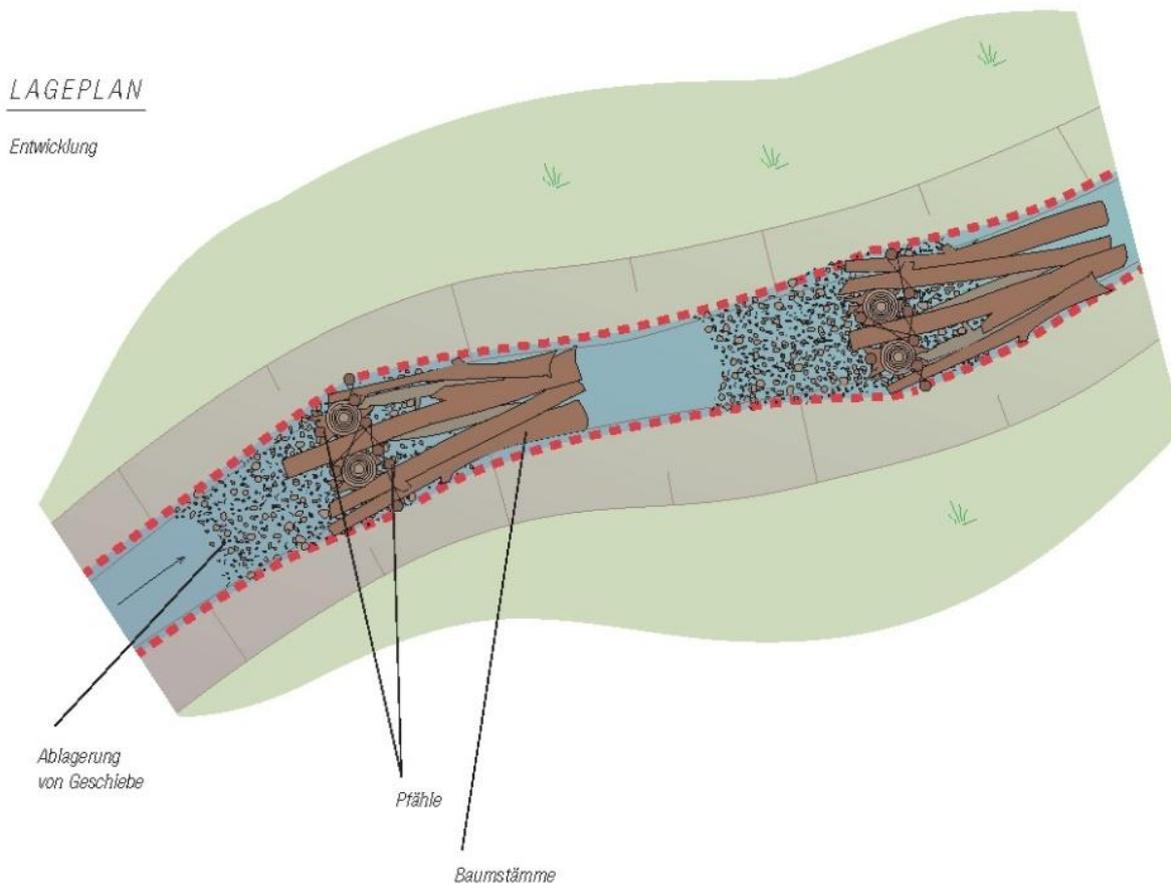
Grundschwelle aus Totholz Lageplan (LfW Rheinland-Pfalz, 2003)
